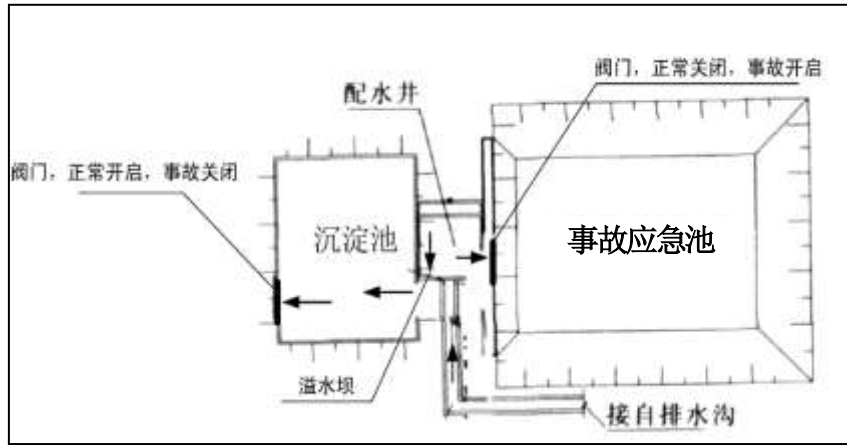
沉淀池与事故应急池平面布置示意
